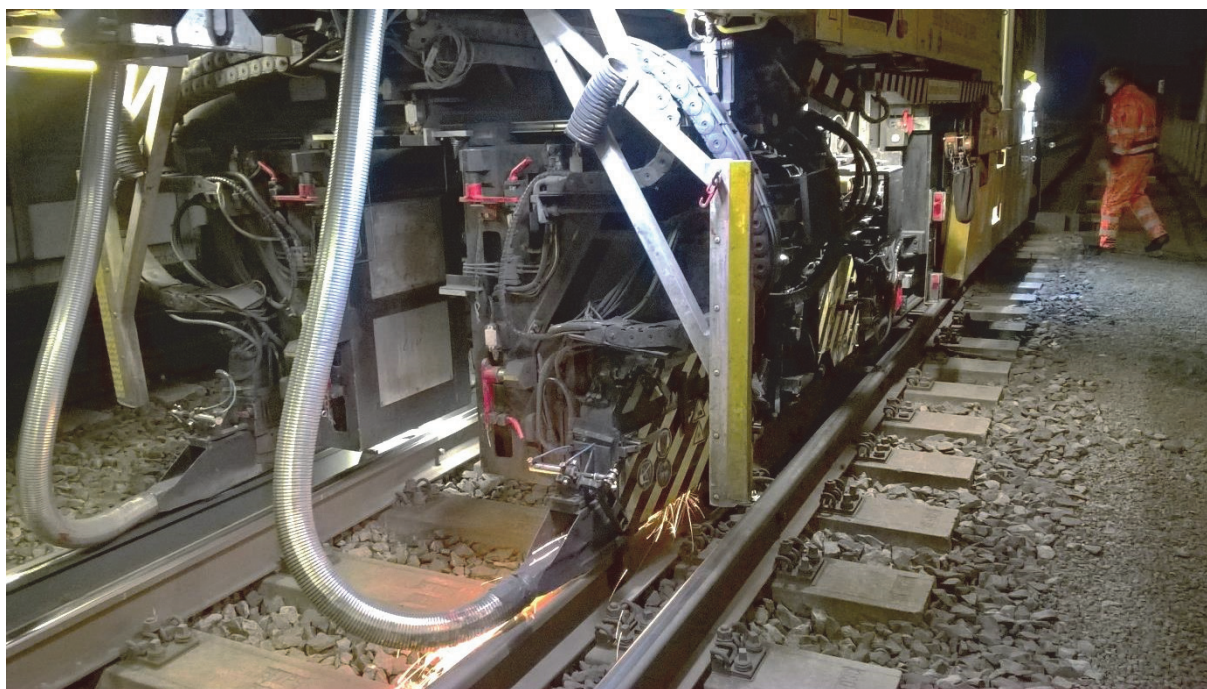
Frézovací stroj Linsinger SF02-FS Truck
